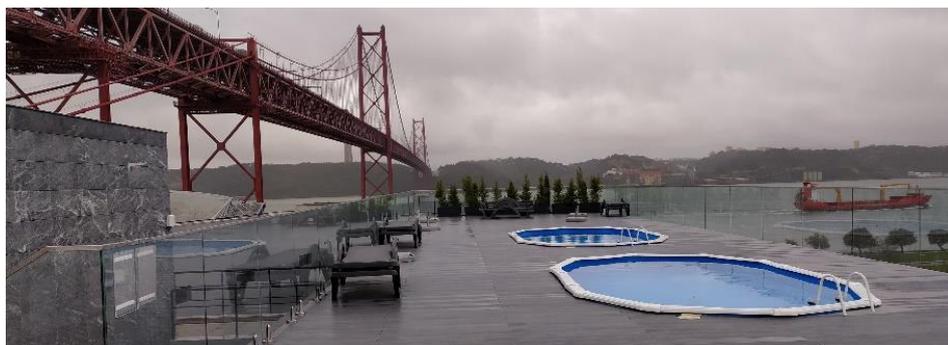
Cobertura plana recentemente renovada no hotel em ambiente consolidado, com estrutura sobreelevada inserindo pequenas piscinas, zona para solário e apoio de bar
